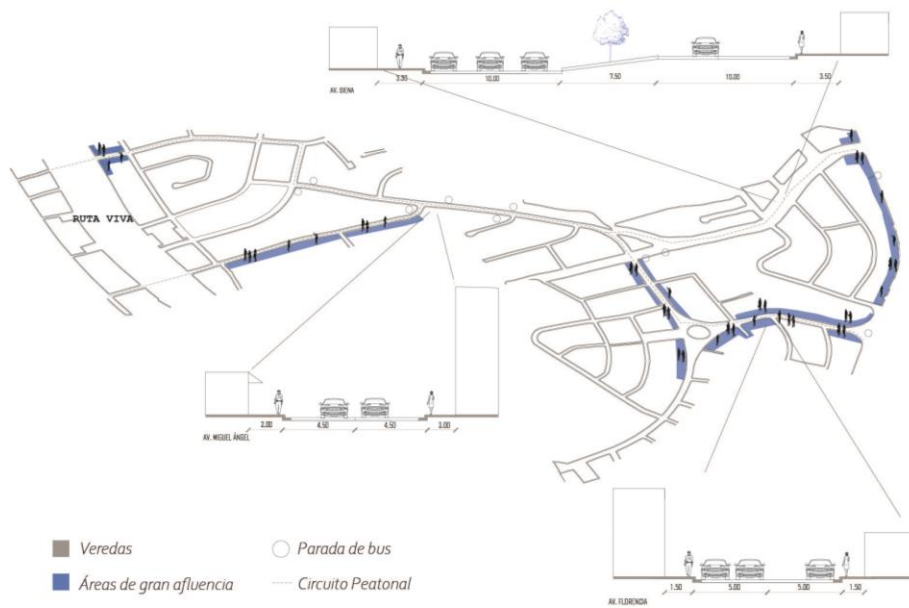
Tipologías viales. Elaboración conjunta Taller 9
